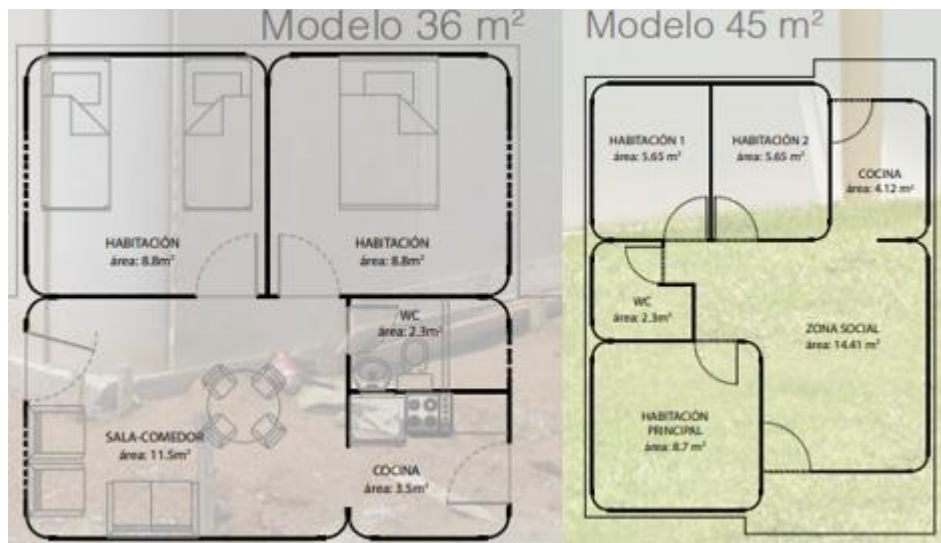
Imagen diseños arquitectónicos posibles ETERNIT.
